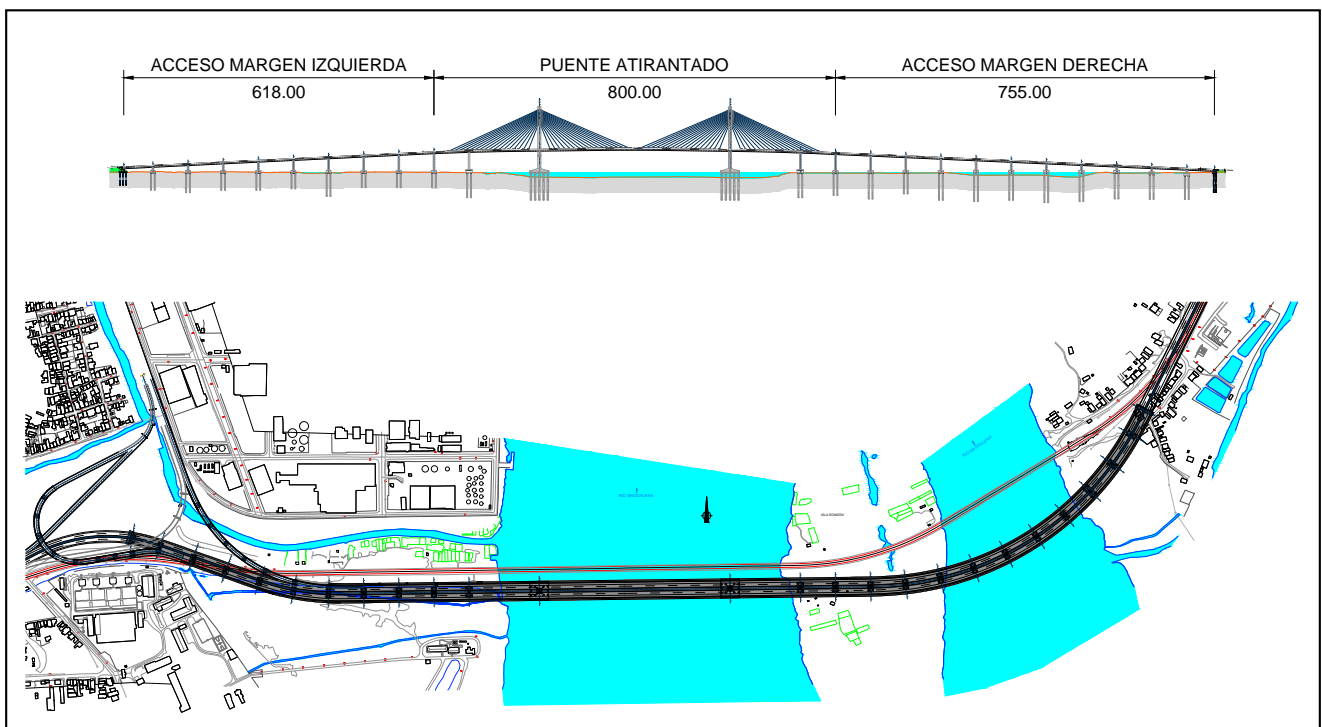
Alzado y planta general de la estructura del nuevo Puente de Pumarejo.
